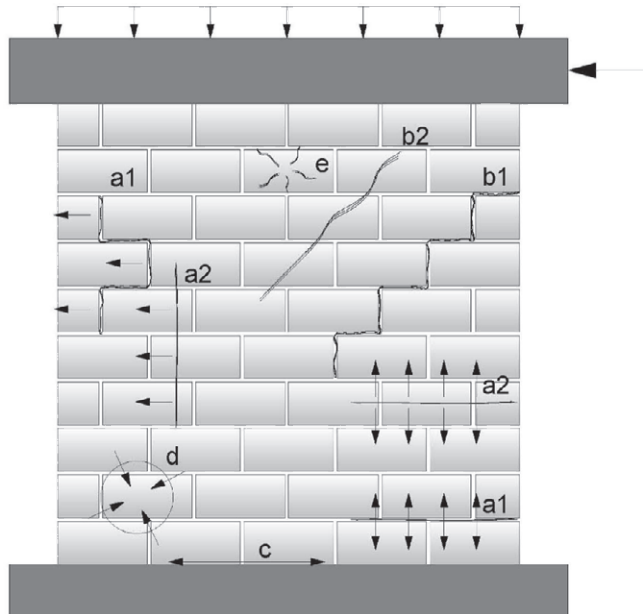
Risstypen in Mauerwerksstrukturen [Münich 2011]
